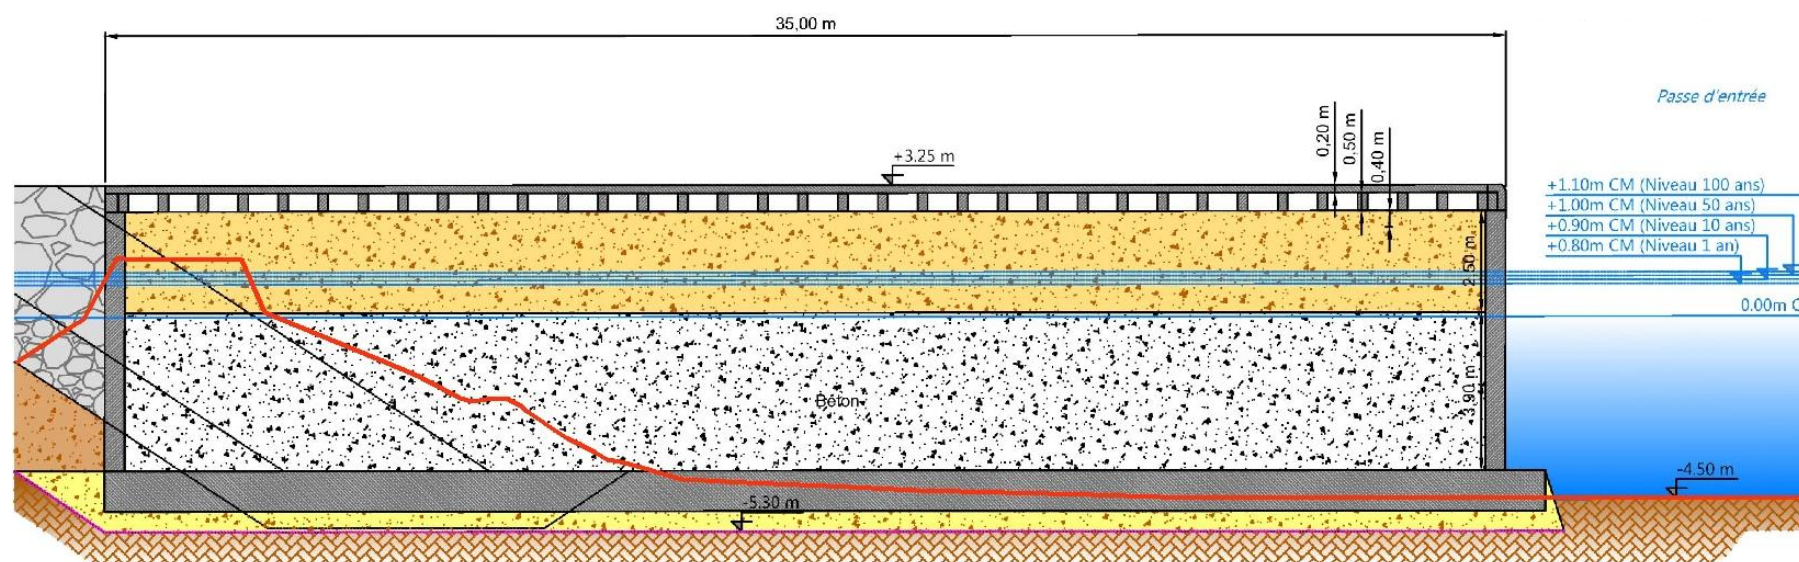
Tenon Ouest solution caisson poids – Coupe 3 - — : Profil du terrain actuel
